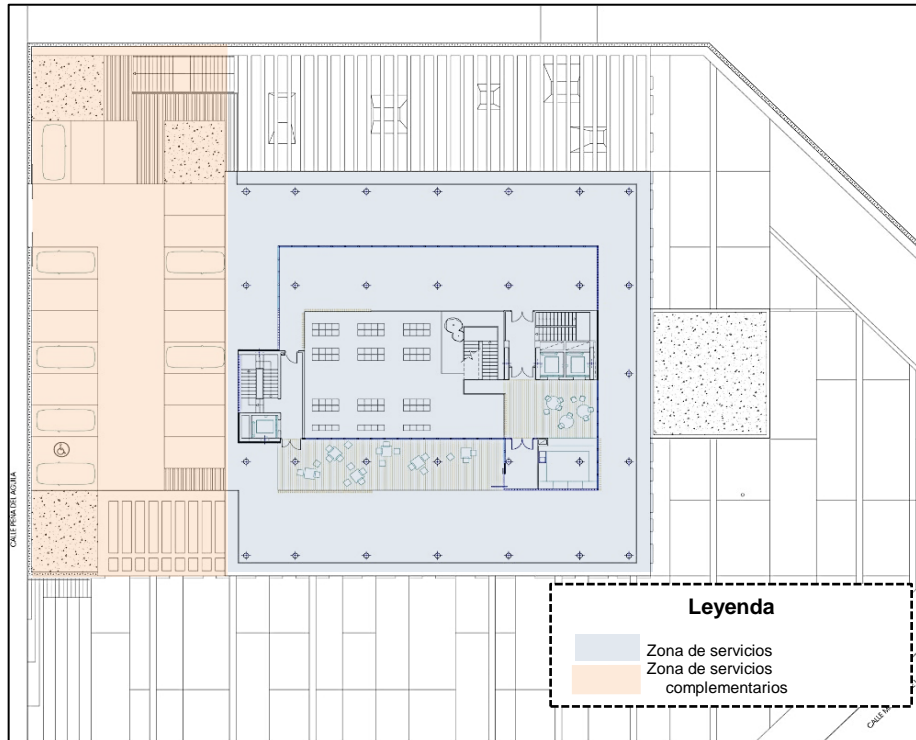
Esquema planta baja – Comisaría Fuencarral
